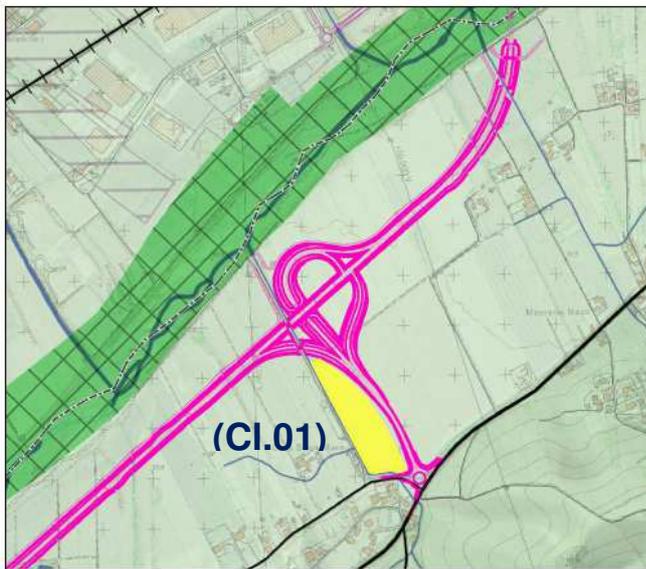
Dettaglio sovrapposizione Area Cantiere Base
